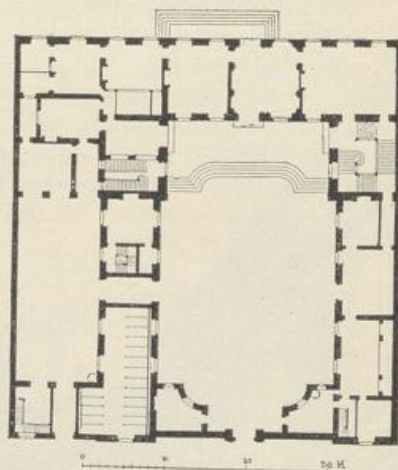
Grundriss des Hotels Chevreuse
